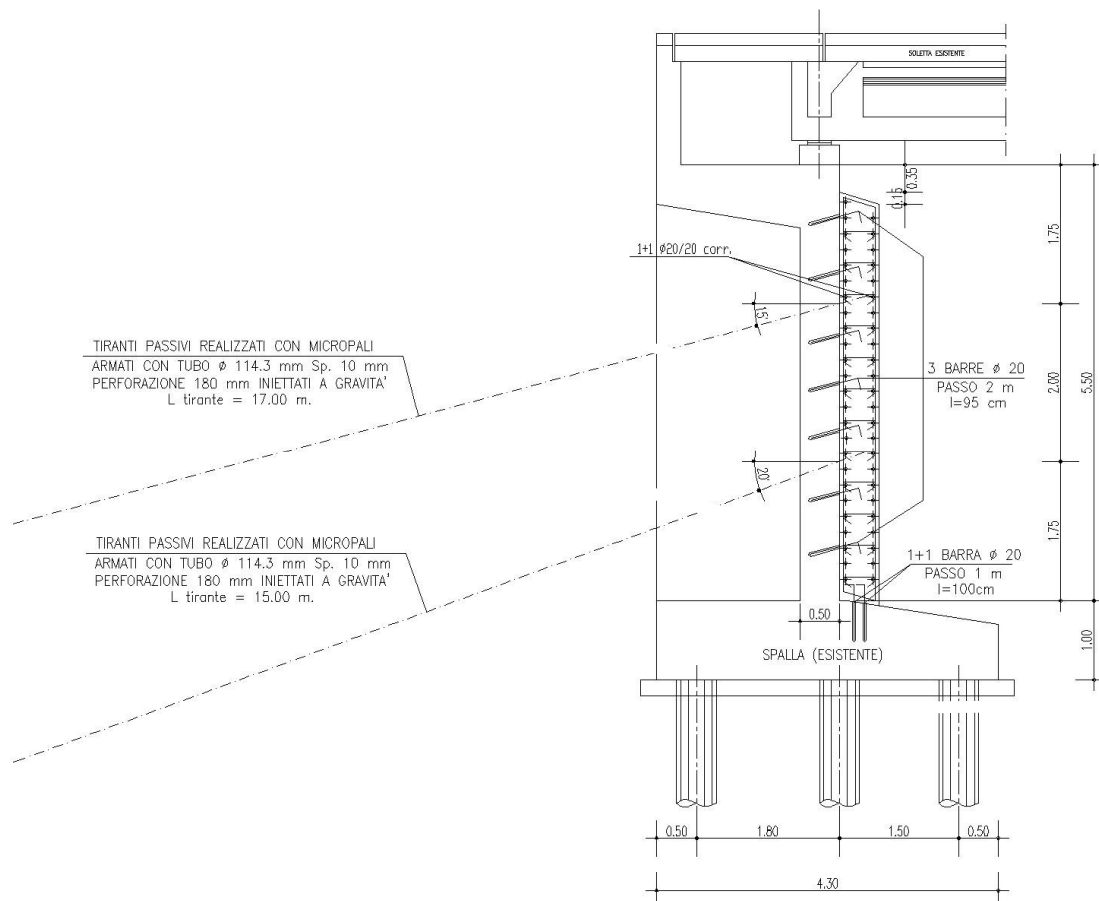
Spalle – Sezione tipo rinforzo strutturale
